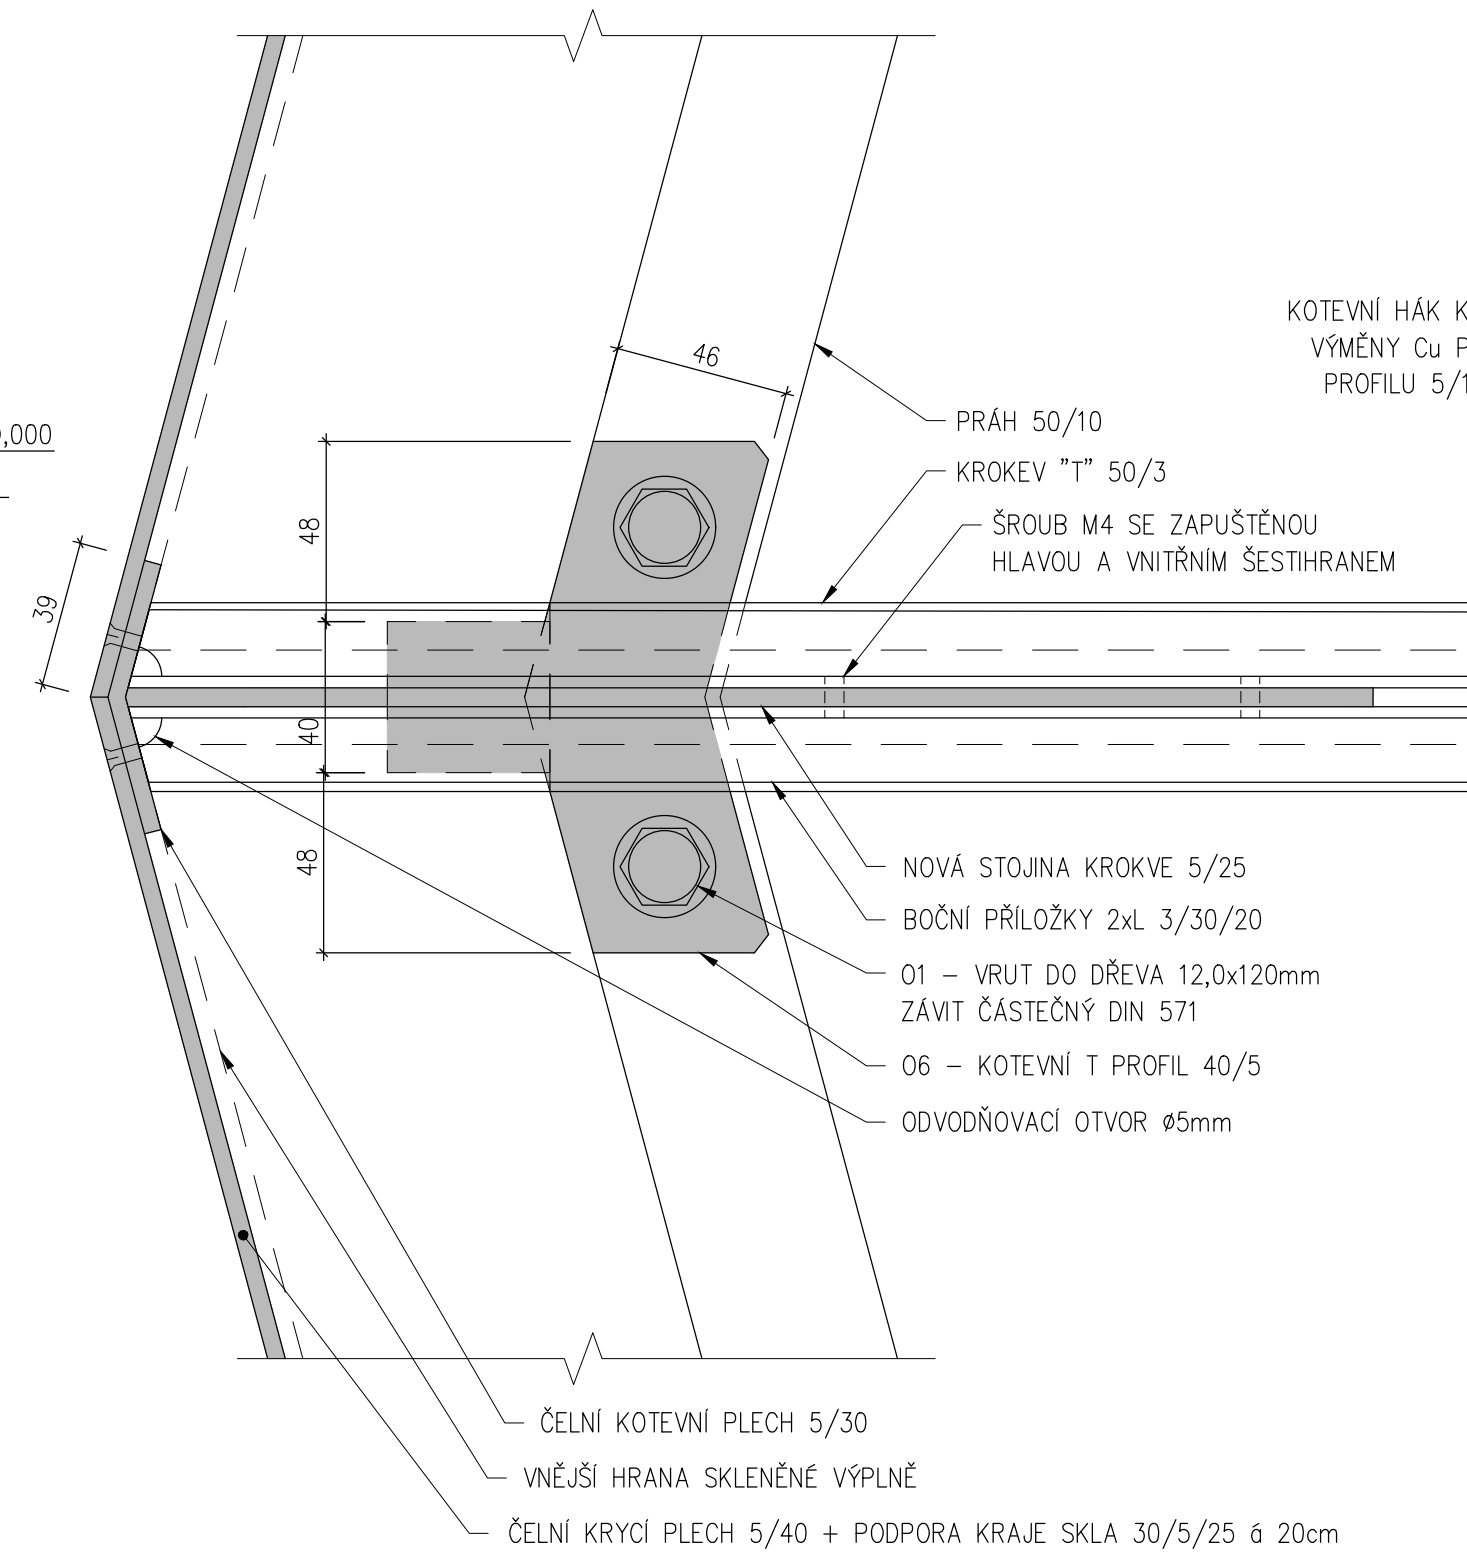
STĚNY LUCERNY V MÍSTĚ ÚŽLABÍ
